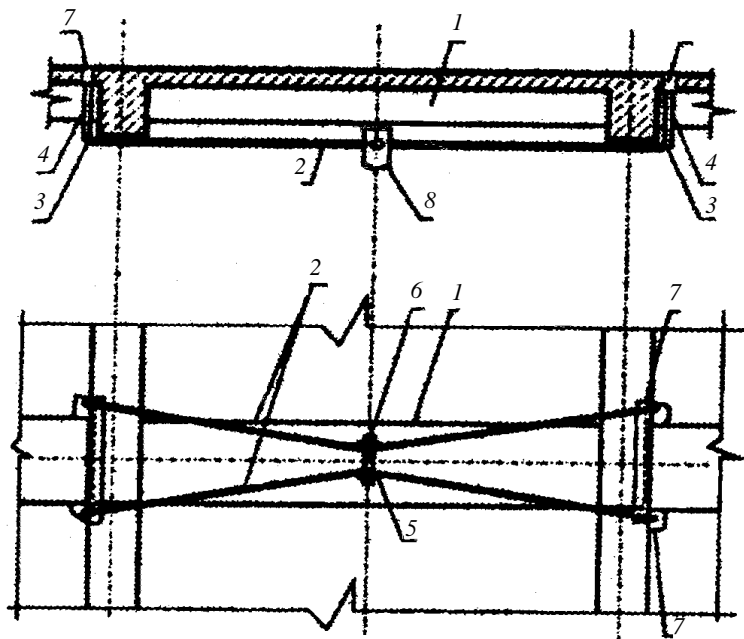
Усиление балки дополнительной предварительно напряженной арматурой (горизонтальные затяжки):
